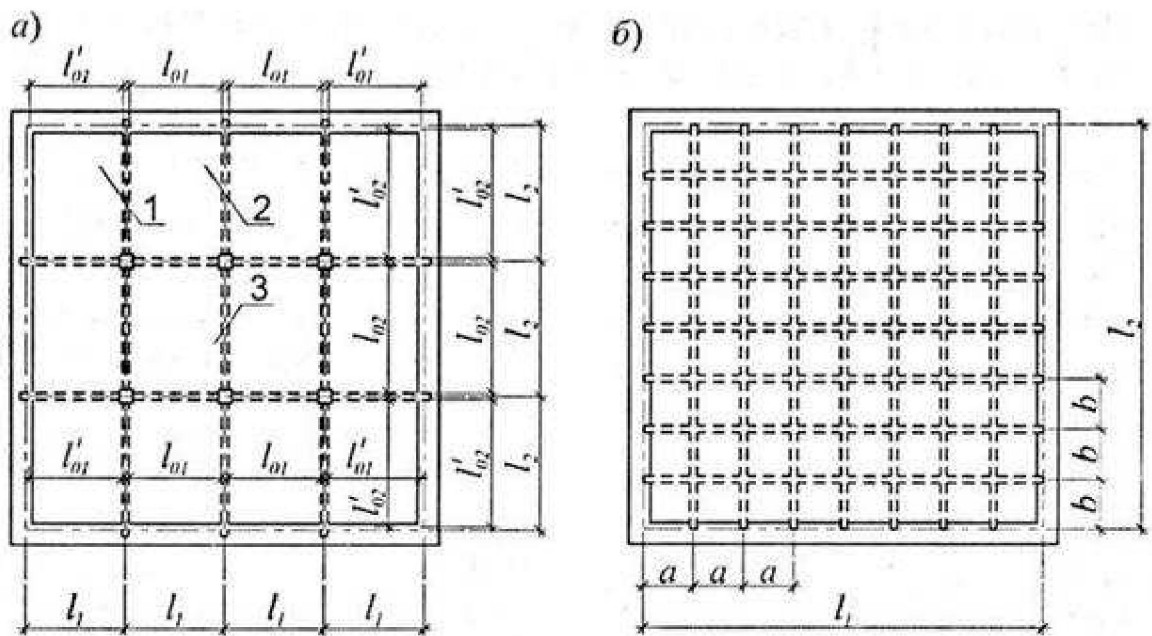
монолитное ребристое перекрытие с плитами, опертыми по контуру в плане (а – с внутренними колоннами (плиты больших пролетов); б – без внутренних колонн (кессонные перекрытия)) [38]
